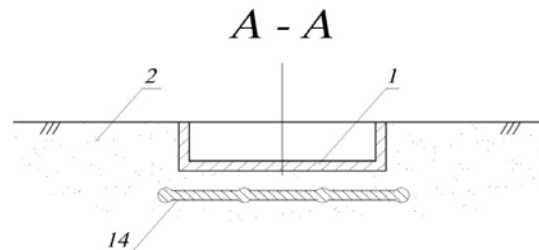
Переріз захисного екрана: 1-споруда; 2-ґрунт; 14-захисний екран
